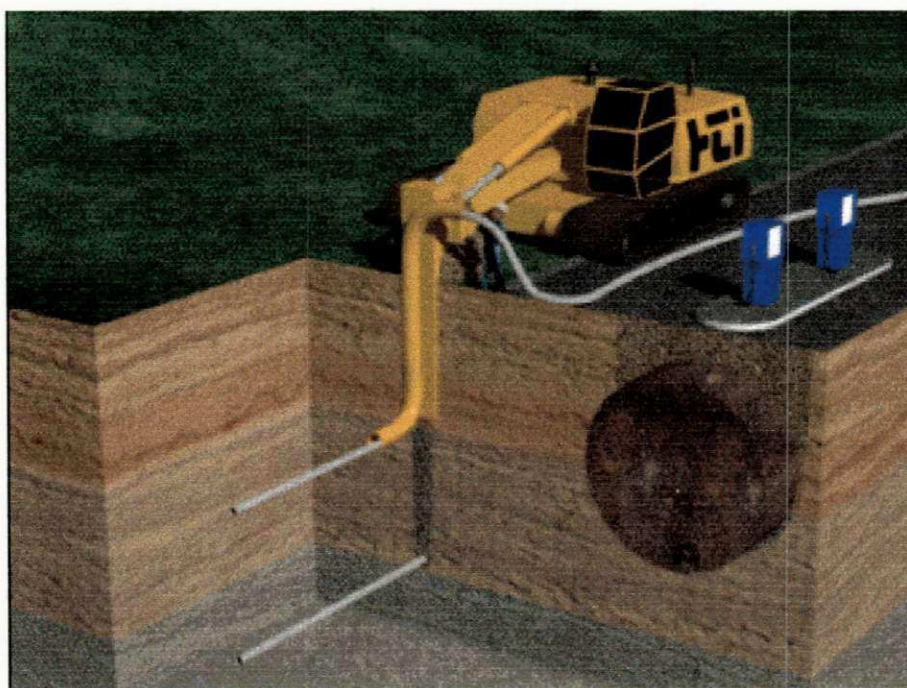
Instalação de um Poço Horizontal (Fonte: www.horizontal.com)
